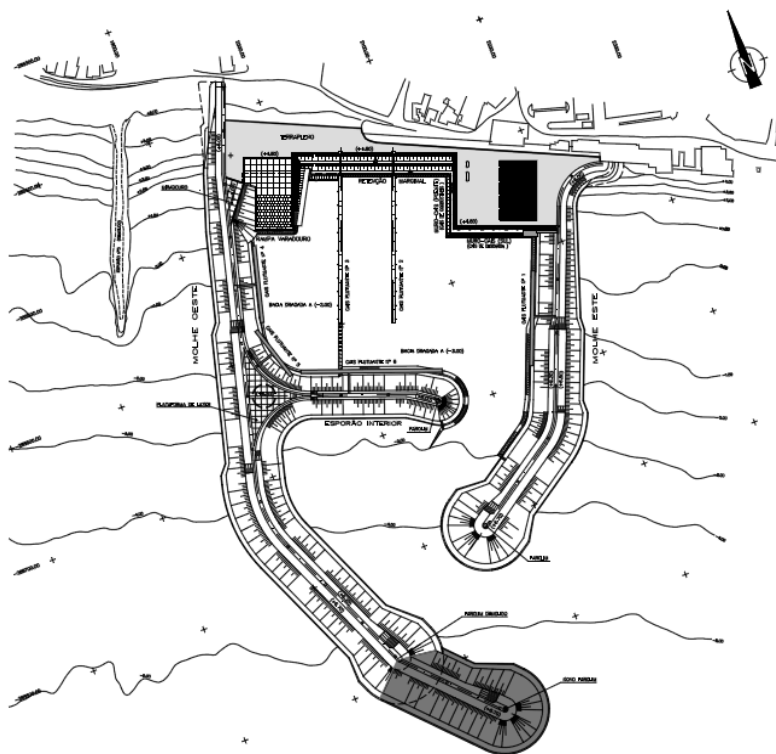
Planta do porto de pesca da Quarteira. [1]
